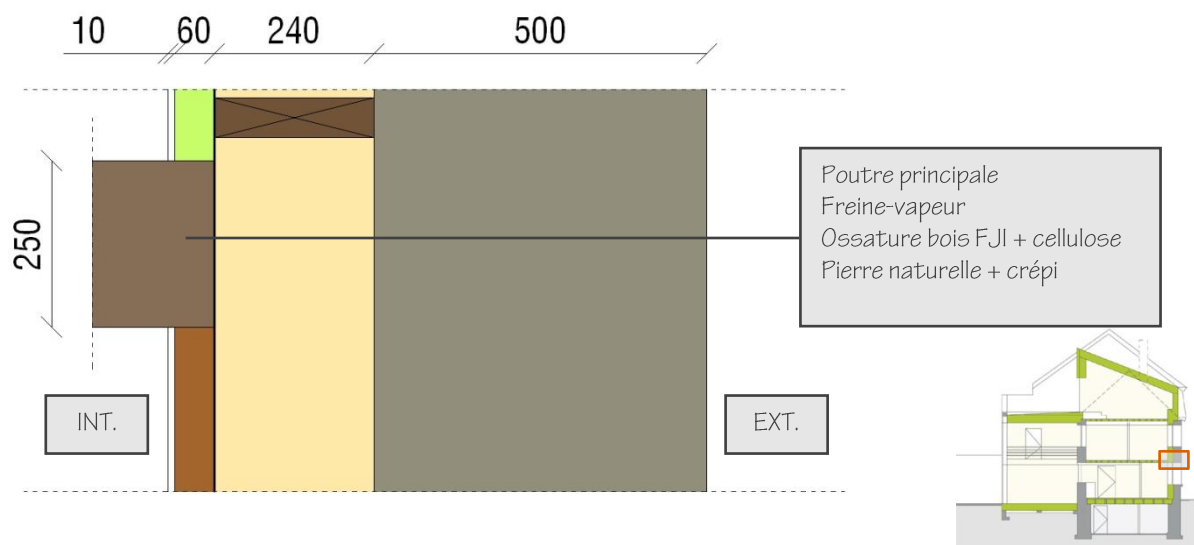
Détail de la poutre coupée pour l'isolation de la façade avant, mesures en [mm]
